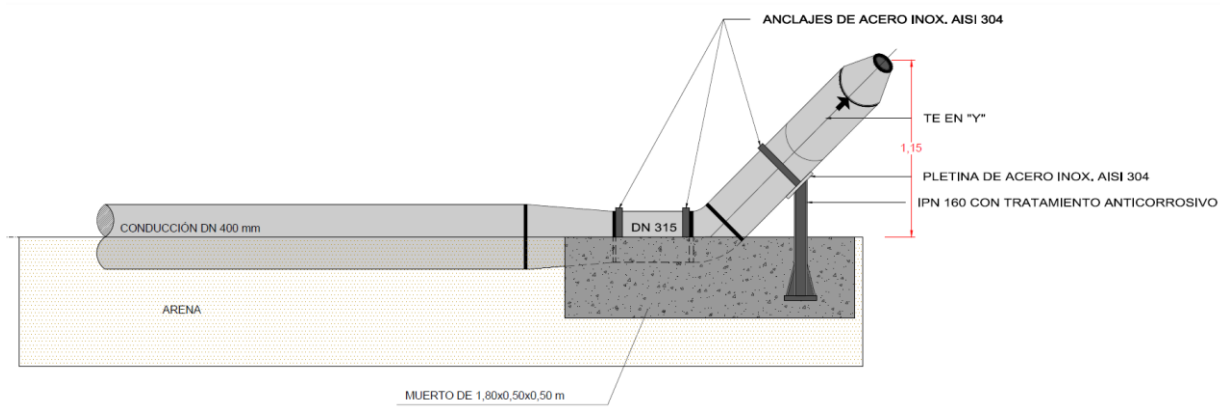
Detalle del sistema difusor (Alzado)
